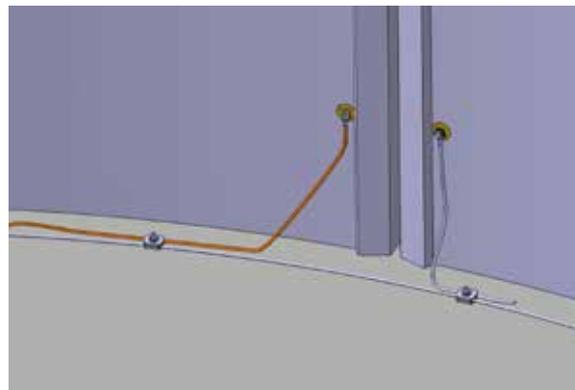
Betontürme: Erdungsleiterverbindung zum Fundamentring
